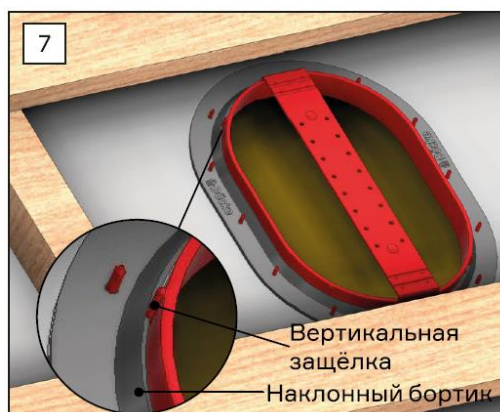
Сборка верхней и нижней части гидрозатвора.
